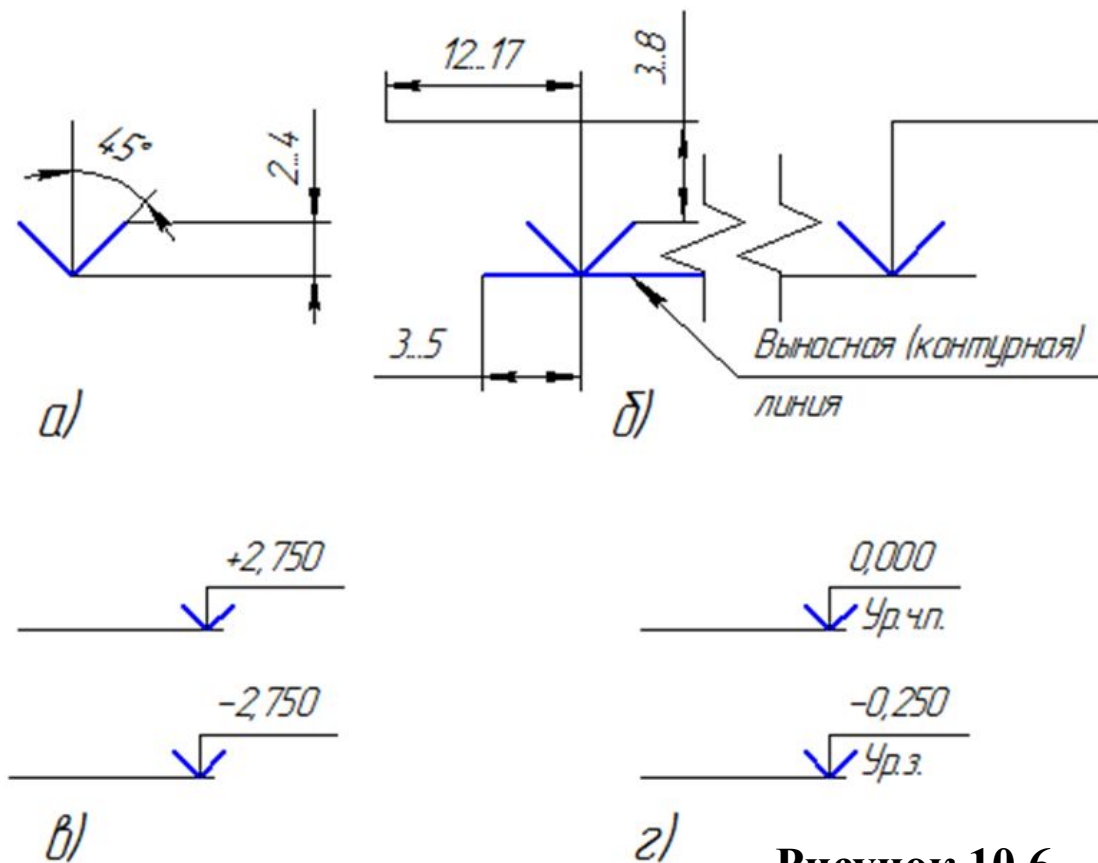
Нанесение высотных отметок на чертежах фасадов, разрезах, сечениях:
